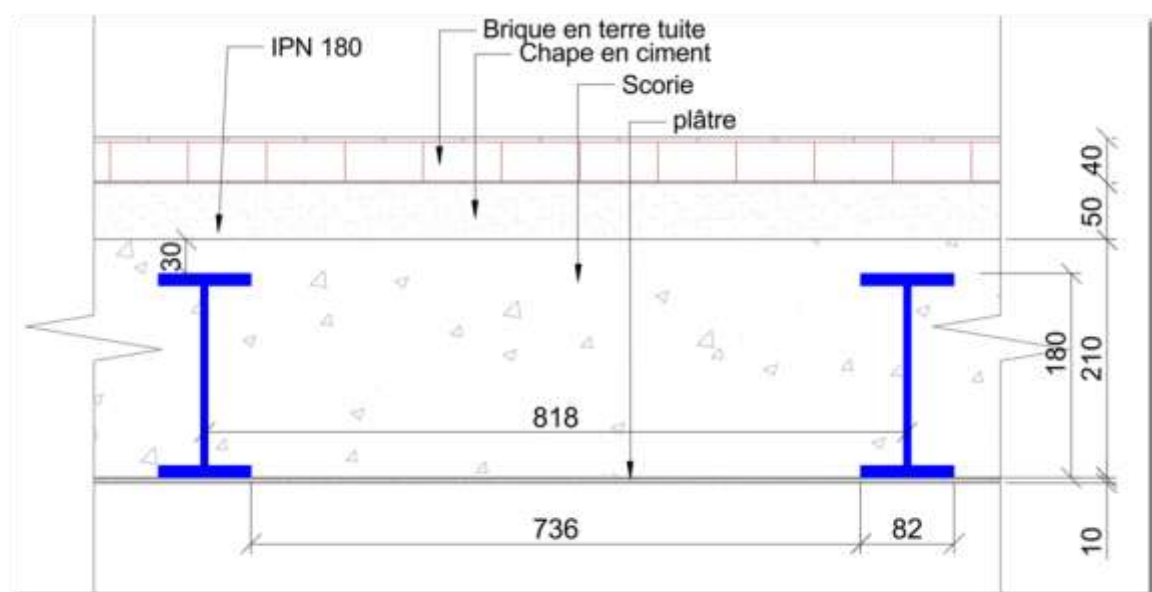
Coupe du plancher Sds-0.2 (portée 5,72 m)
